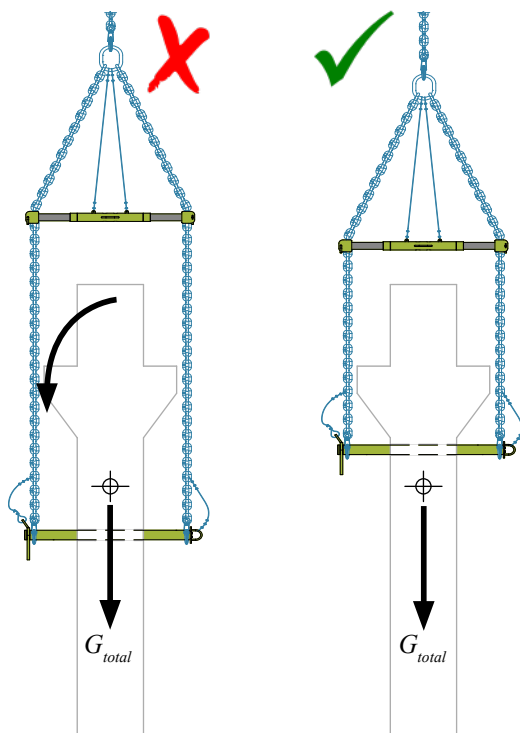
Posizionamento del punto di sollevamento rispetto al baricentro del pilastro.
